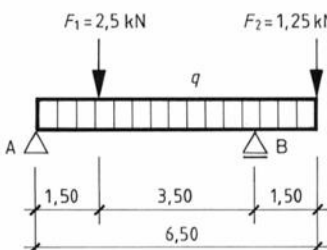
/6: Kragträger mit Streckenlast und 2 Einzellasten
